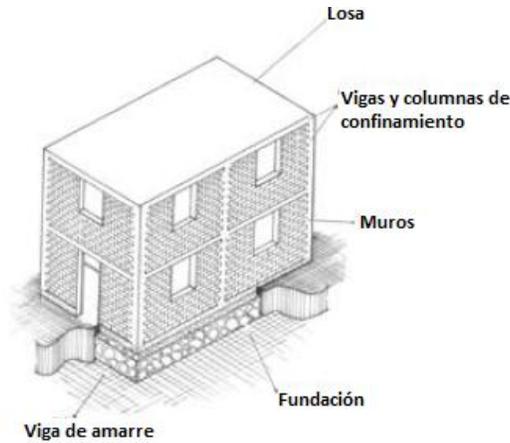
Edificio típico de mampostería confinada (fuente: Blondet 2005).
